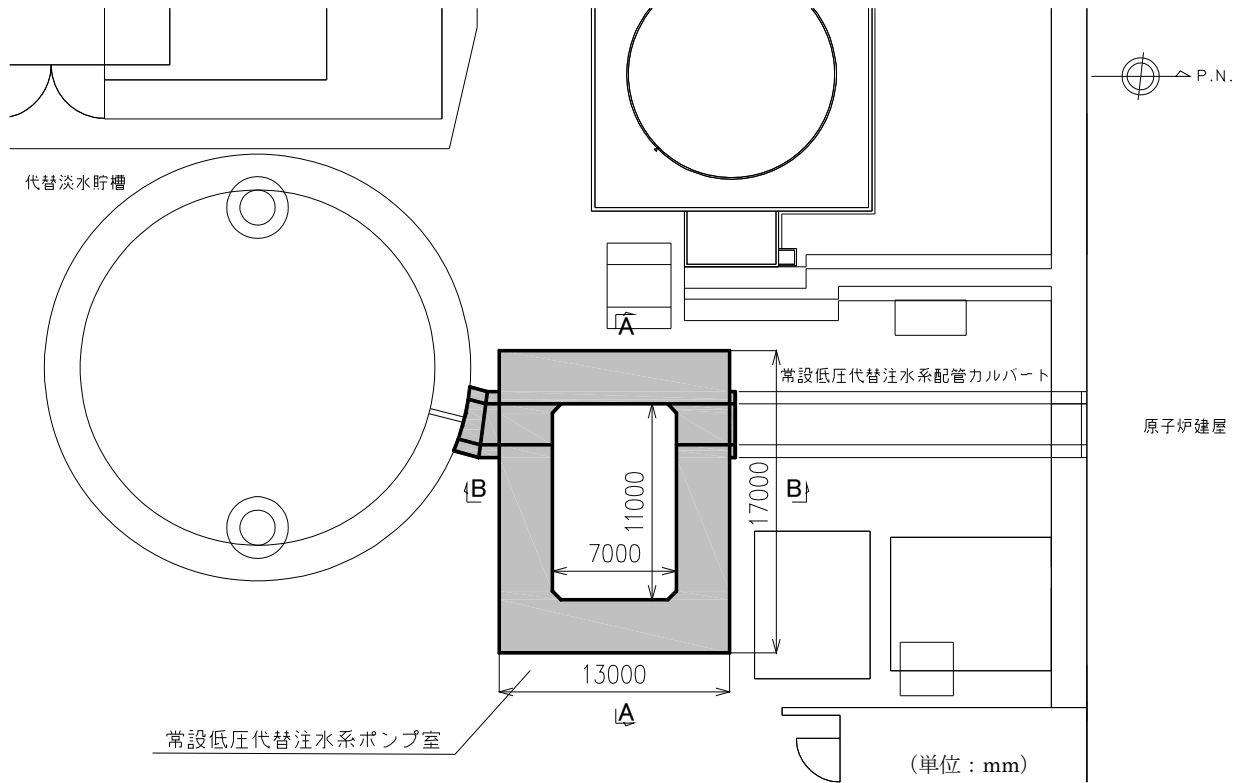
(2) 常設低圧代替注水系ポンプ室 平面配置図 (拡大図)
